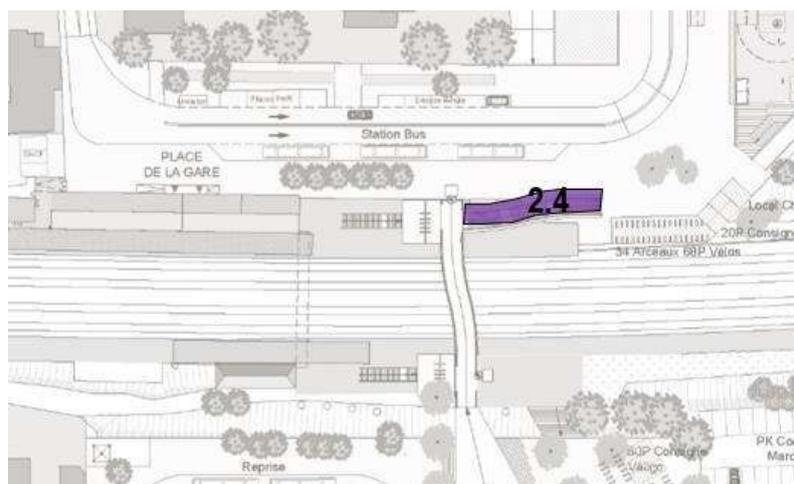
Escalier/rampe piétons vélos Place de la Gare Nord-Ouest
